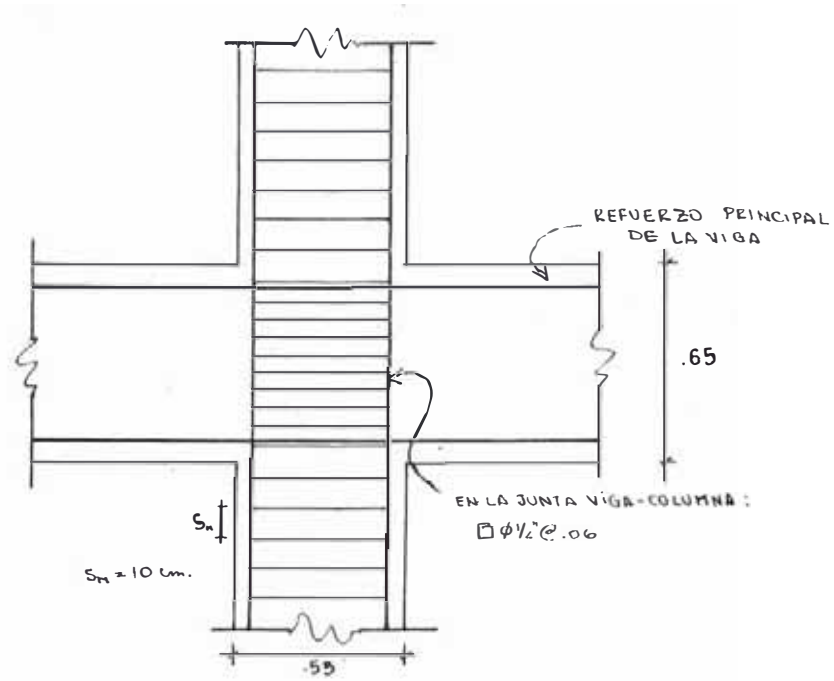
DISTRIBUCION DEL ACERO EN LA JUNTA VIGA-COLUMNA (DIRECCION Y)
